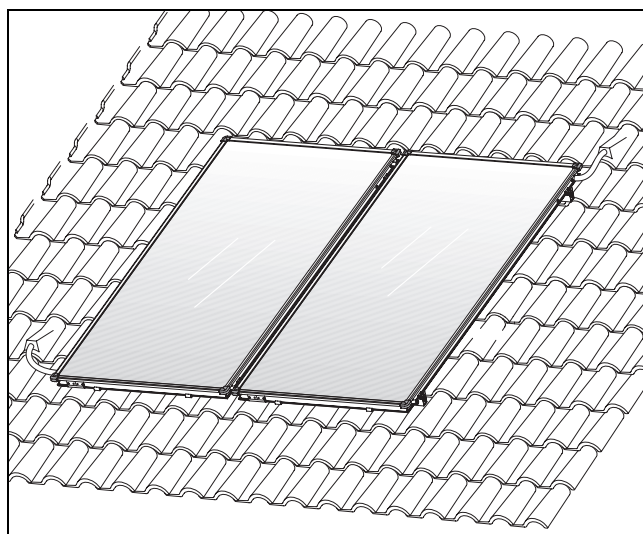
Imagen del montaje de los captadores sobre tejado inclinado
